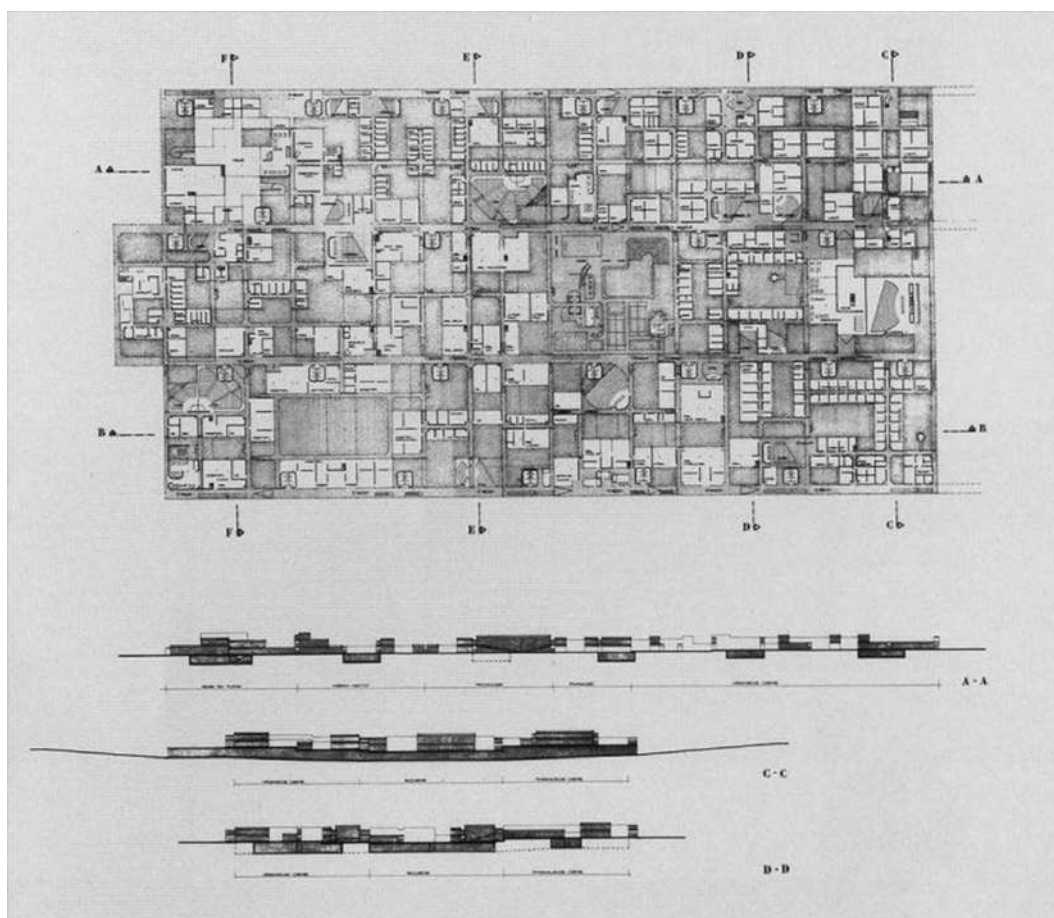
Main Building. Dahlem Campus, Universidade Livre de Berlim. Planta baixa e seções longitudinal A-A e transversais C-C e D-D.
